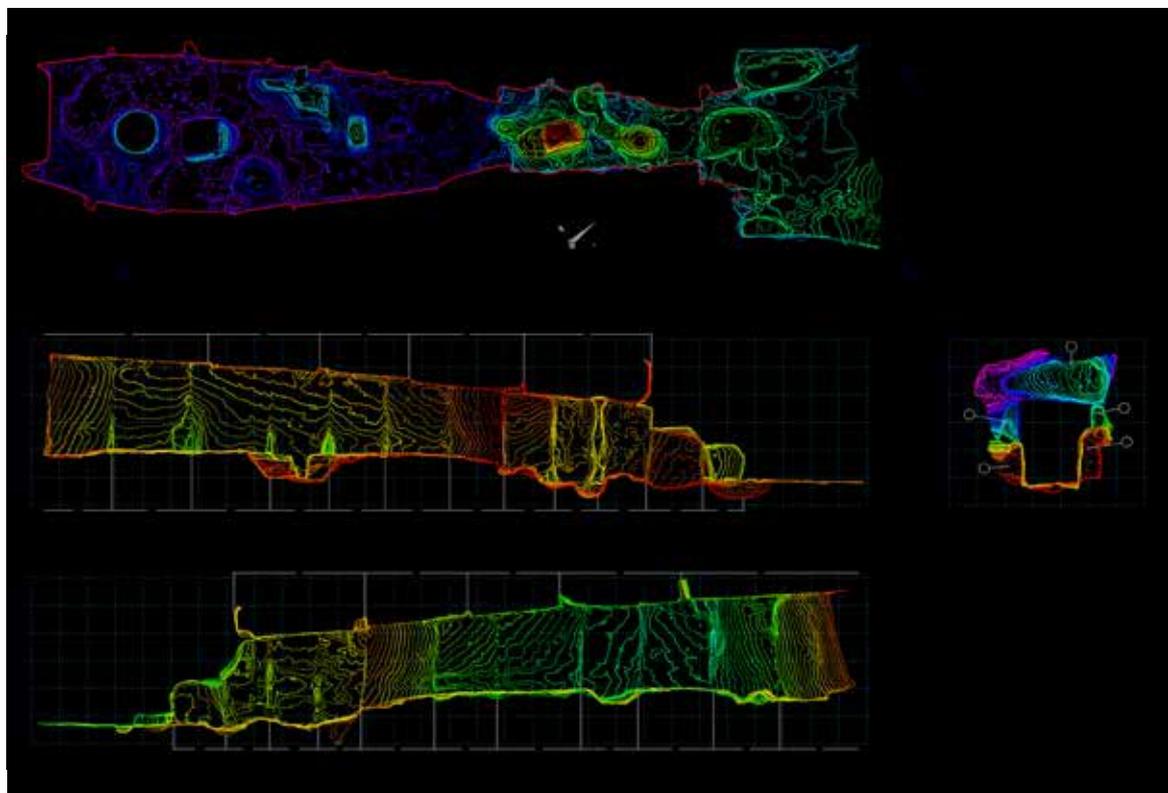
Detalle de la planimetría obtenida del escaneado láser terrestre del dolmen de Menga (planta, alzados y sección). Imagen: TDTEC
